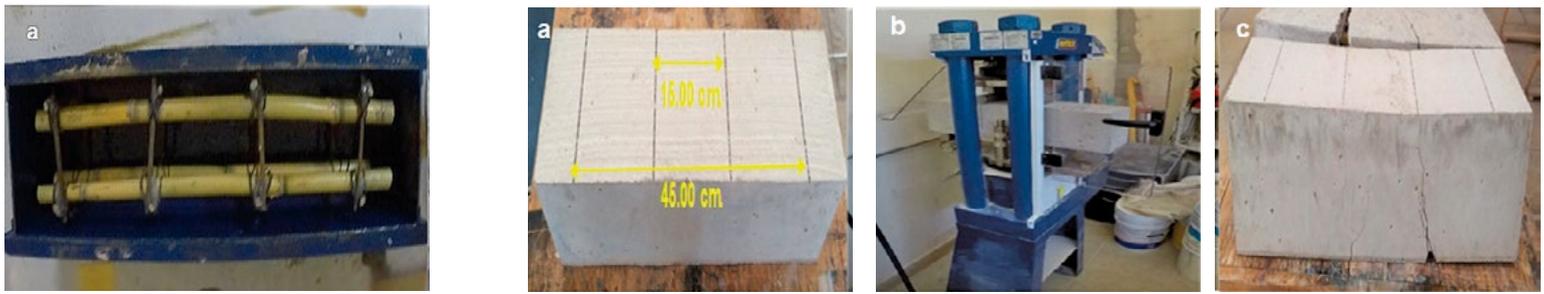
a) Marca de las vigas; b) Viga en prensa; c) Viga ensayada. Fuente: Rubio Sánchez (2019).
